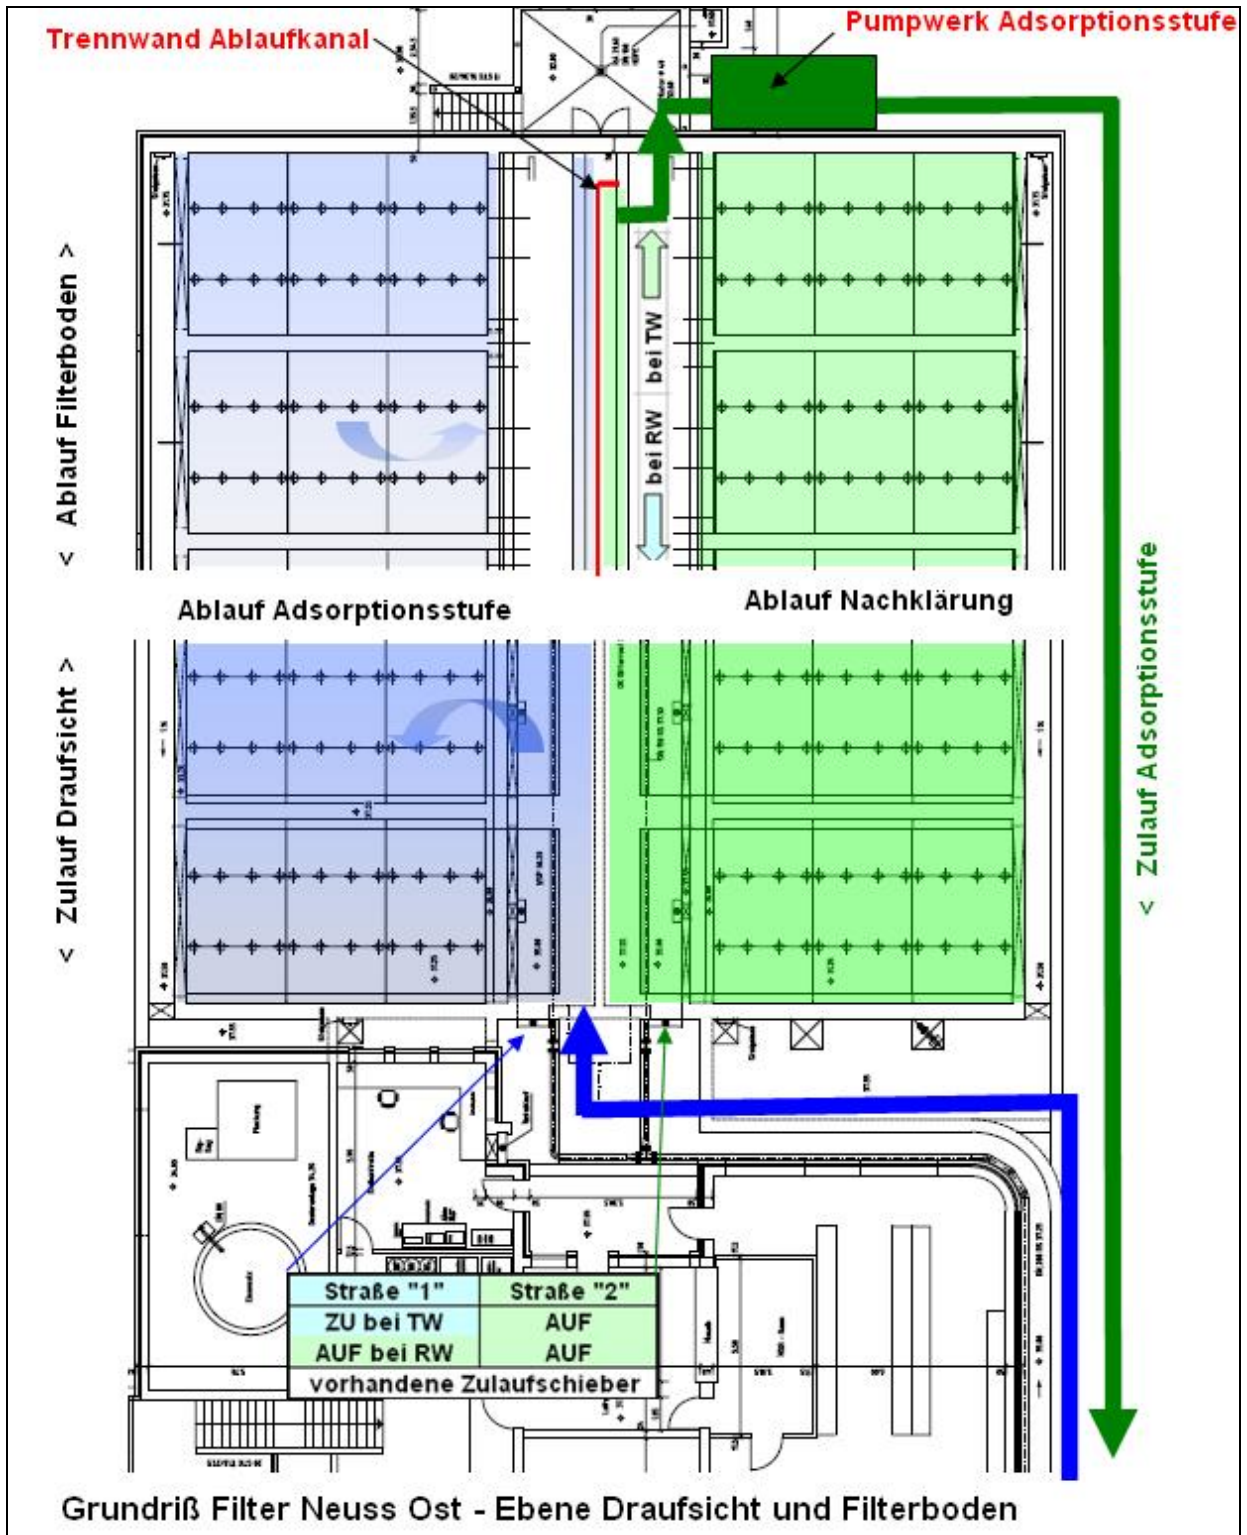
Grundriß Filter Neuss – PAK Dosierung im Bypass nach dem Filter
